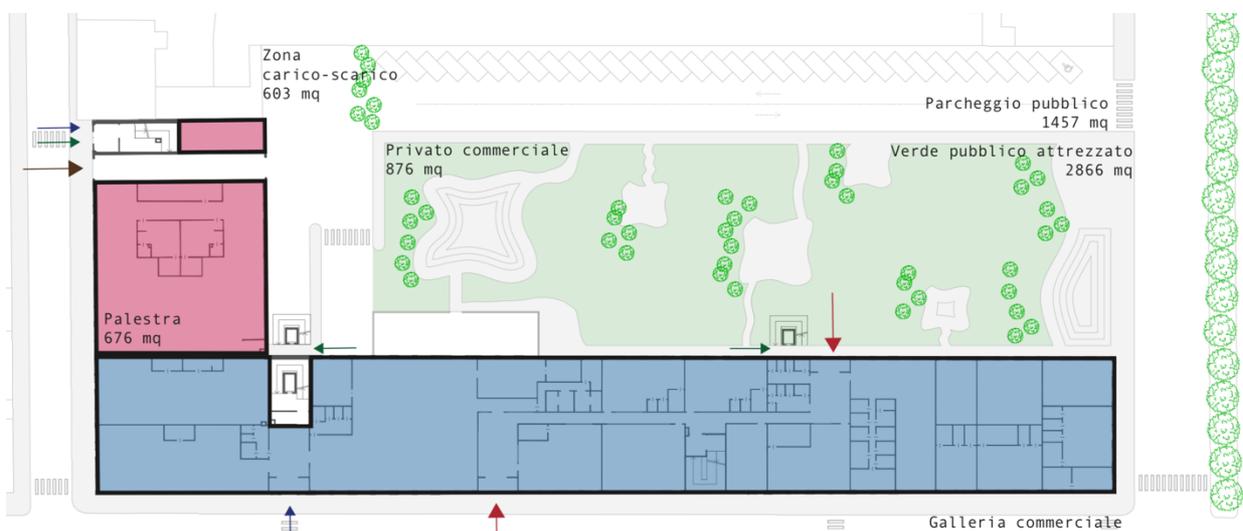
Distribuzione al piano terra. Pianta non in scala. Estratto da tavola 2.
